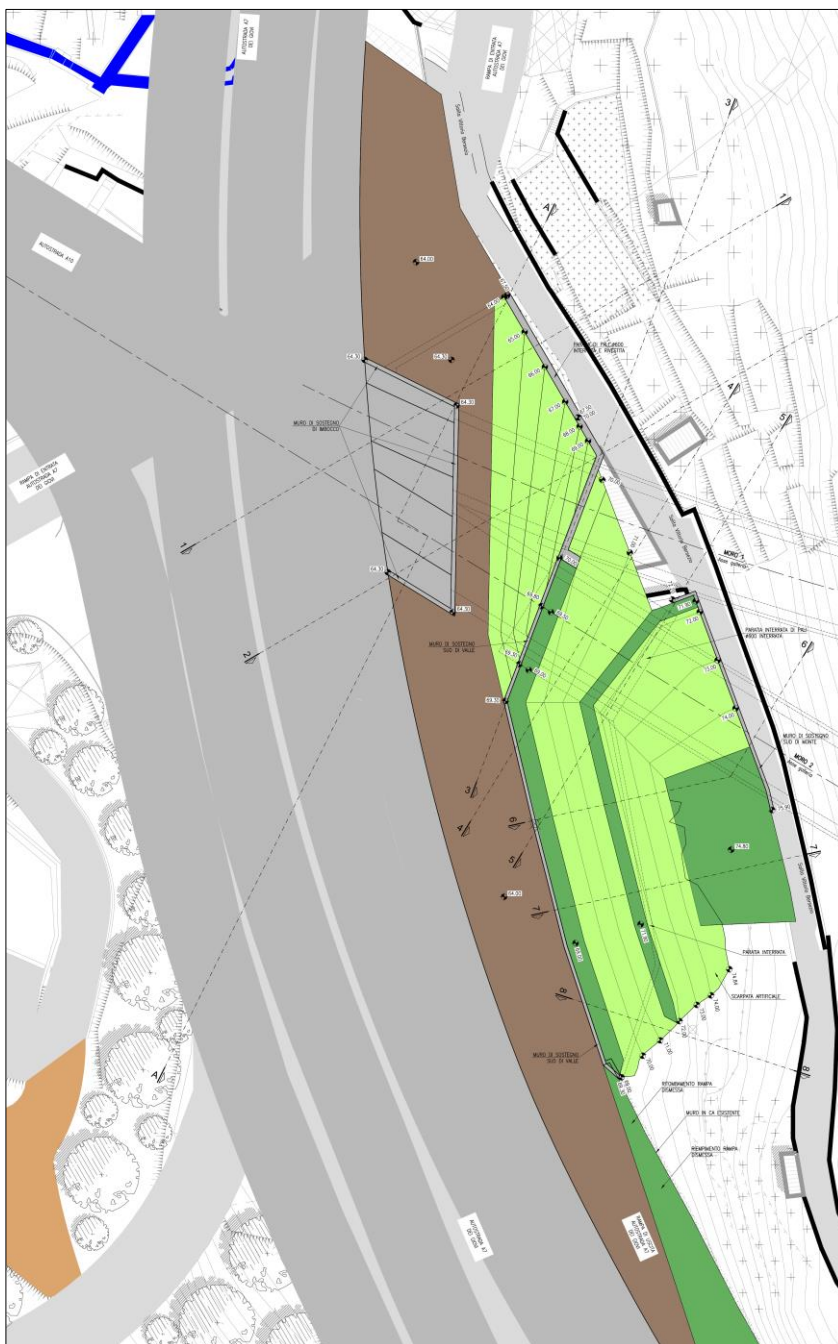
Planimetria stato finale nuova area di imbocco (fonte: elaborato 110721-LL04-PE-S5-G19-GF19W-SSF00-D-AUA4222-1)
